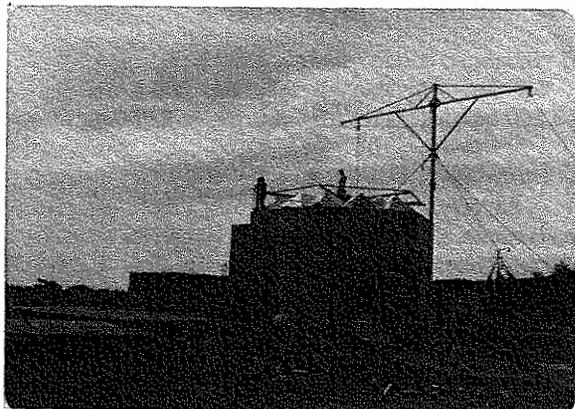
Planta "Las Acacias". 1978. En construcción de la Cámara Piloto, que formará parte de una batería de 18 cámaras más. Ver Cuadro No. 1
